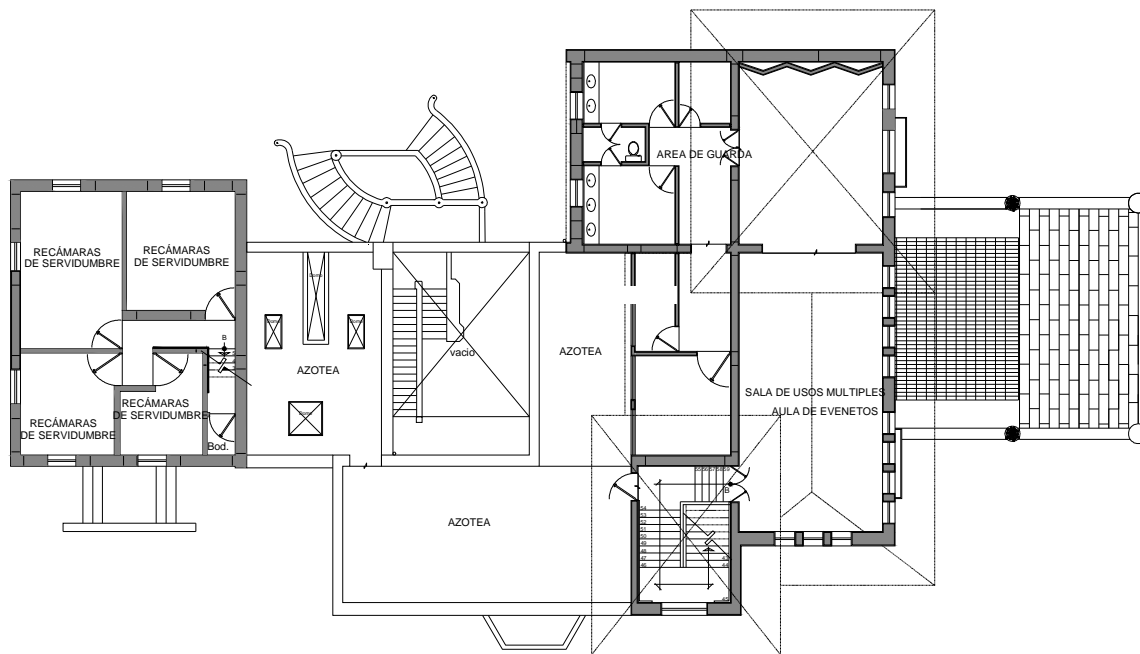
Planta arquitectónica, primer nivel de la Casa Oteló.
